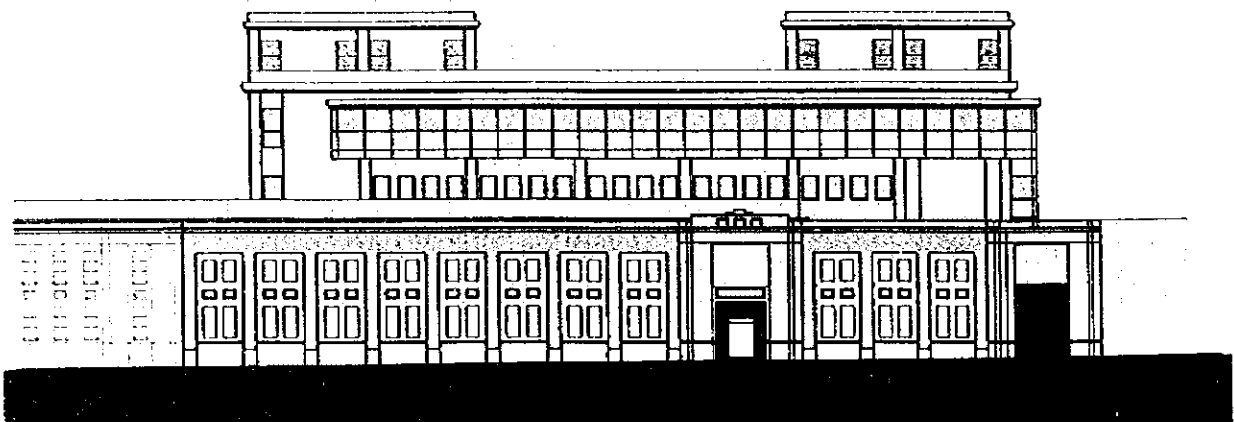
Plano de elevación del nuevo Pabellón Obstétrico dentro de la zona monumental
